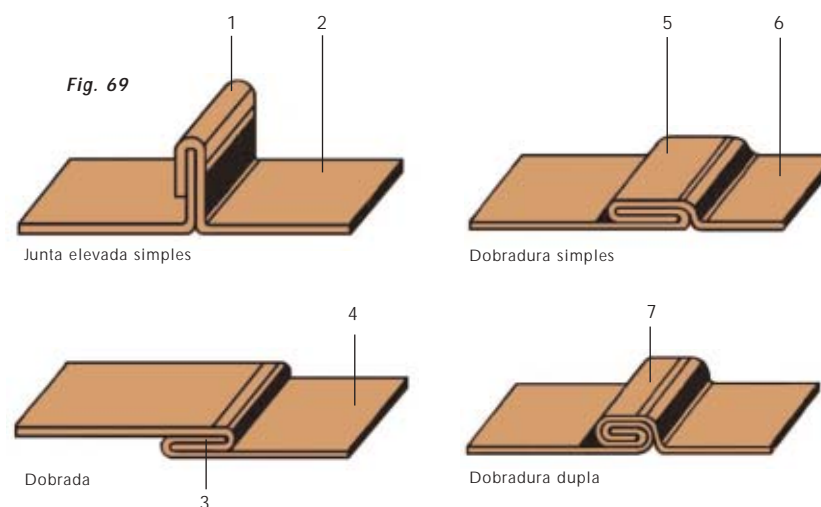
Detalhes juntas elevadas e dobraduras.
